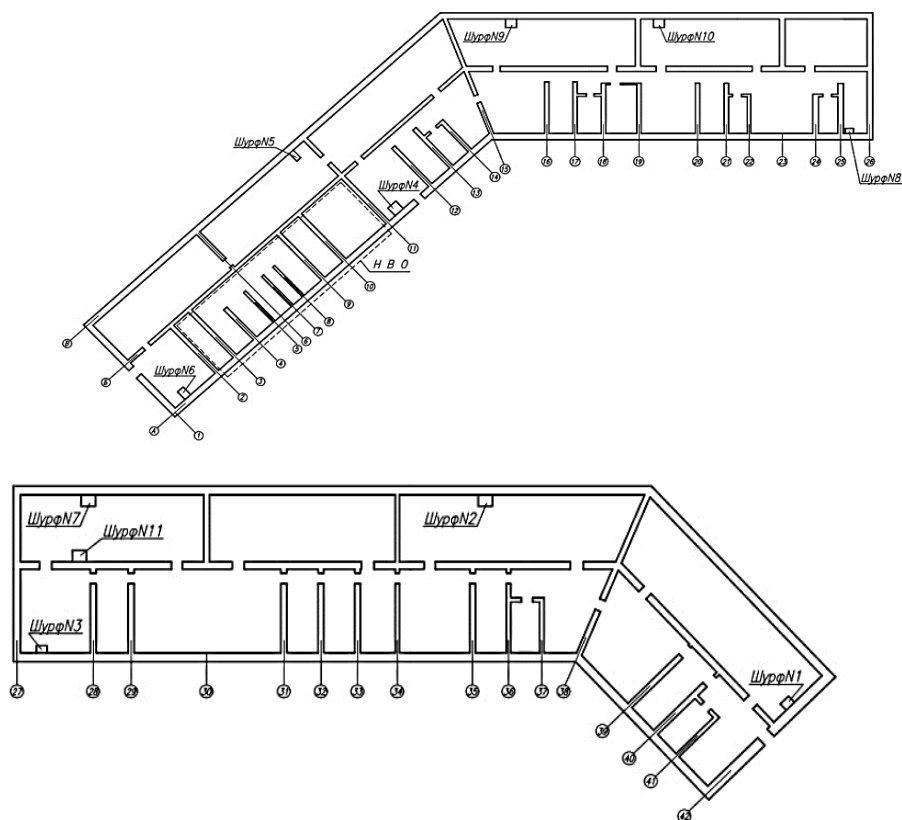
План подвального этажа здания с расположением шурфов и зон обследования
